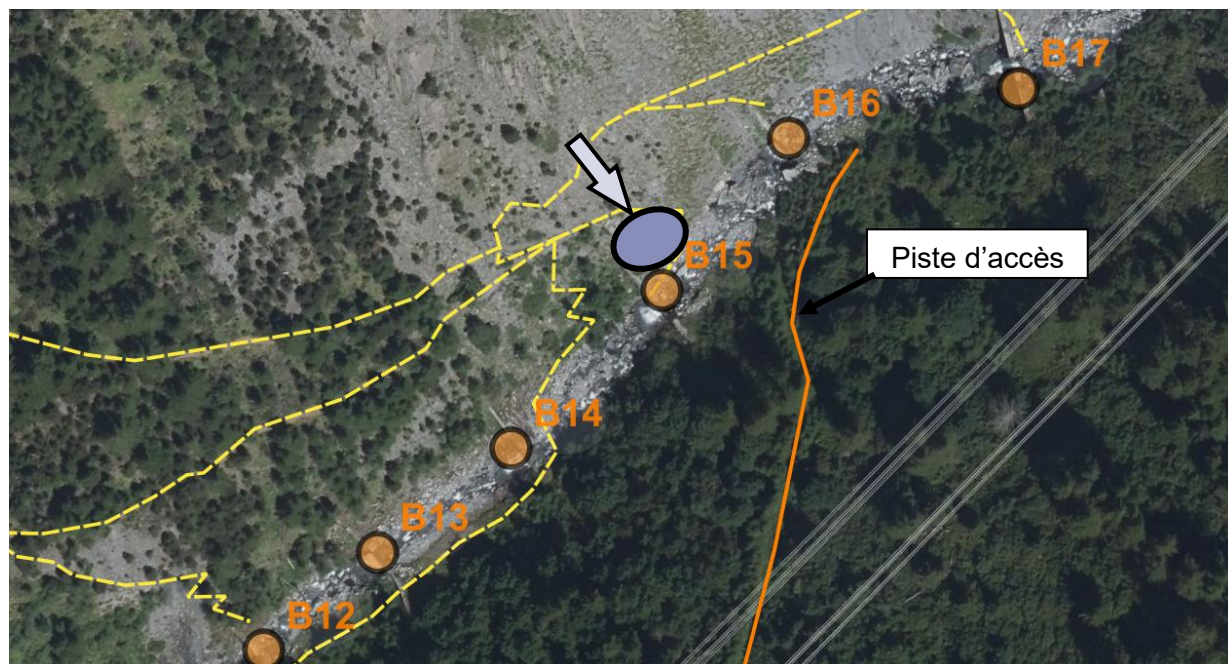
Localisation potentielle de l'aire d'installation de chantier.
